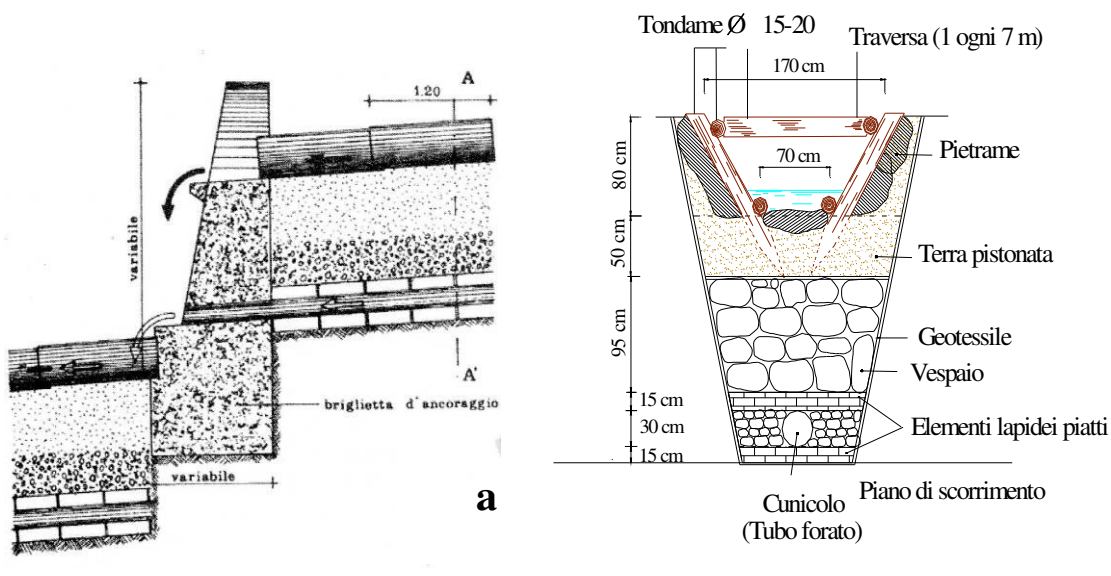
In a sezione longitudinale del dispositivo per il consolidamento di frana poco profonda: trincea drenante e canaletta in prefabbricato cementizio per la raccolta delle acque superficiali (da Puglisi, 1982); in b sezione trasversale della trincea drenante, secondo lo schema precedente, con sovrastante canaletta in legname e pietrame. Le brigliette di ancoraggio servono sia per regolare la pendenza delle canalette, sia per portare fuori e non far entrare in pressione le acque emunte .
